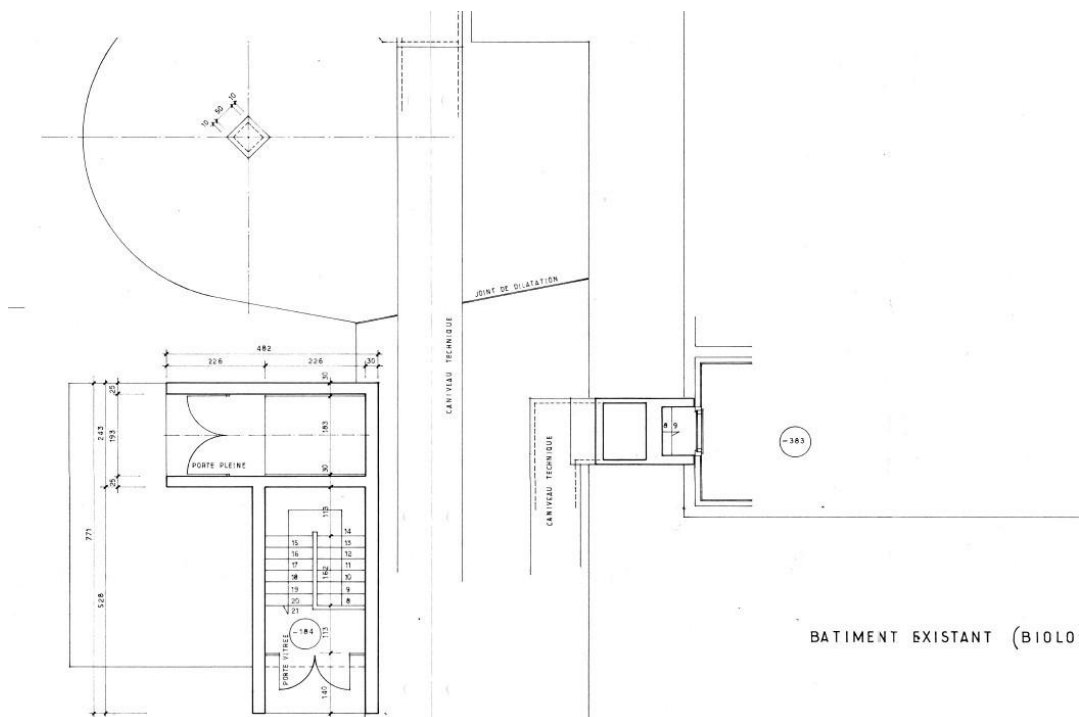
Vue en plan CNB52 – Niveau -1,84
